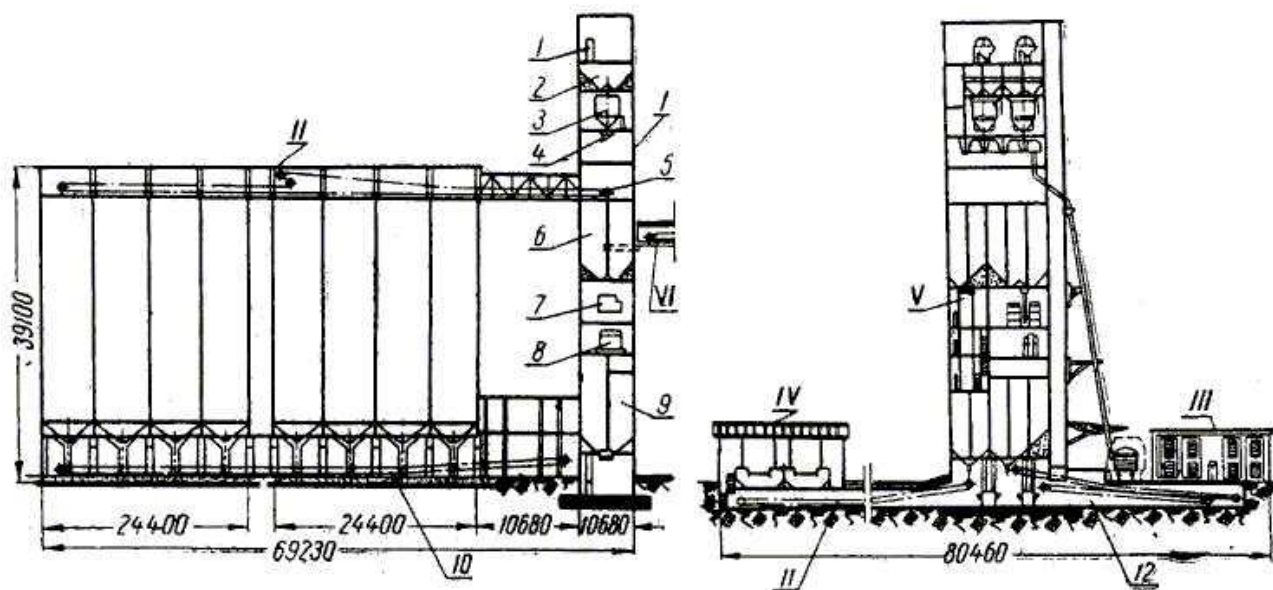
Основные сооружения элеватора: I- рабочая башня; II - силосный корпус; III - приемное устройство с железнодорожного транспорта; IV - приемное устройство с автомобильного транспорта; V - зерносушилка; VI - галерея отпуска на мельницу; 1 - нории; 2 - надвесовой бункер; 3 - ковшовые весы; 4 - распределительные трубы; 5 - надсилосные транспортеры; 6 - надсепараторные бункера; 7 - сепаратор; 8 - контрольный сепаратор; 9 - подсепараторный бункер; 10 - подсилосный транспортер; 11 - приемный транспортер с автомобильного транспорта; 12 - приемные транспортеры с железнодорожного транспорта.
